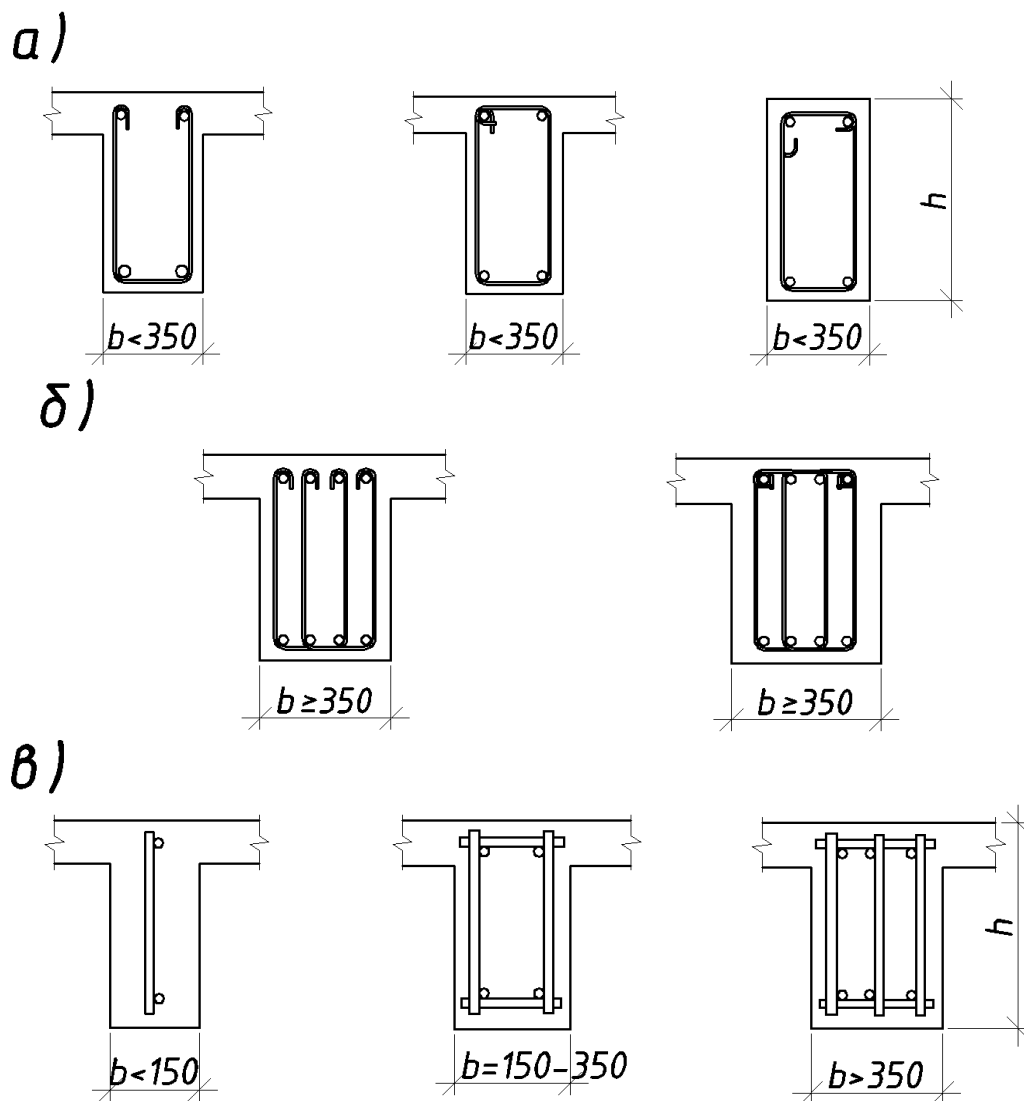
Схемы армирования сечений балок: а – вязаной арматурой, двухсрезными хомутами; б – то же, четырехсрезными хомутами; в – сварной арматурой
